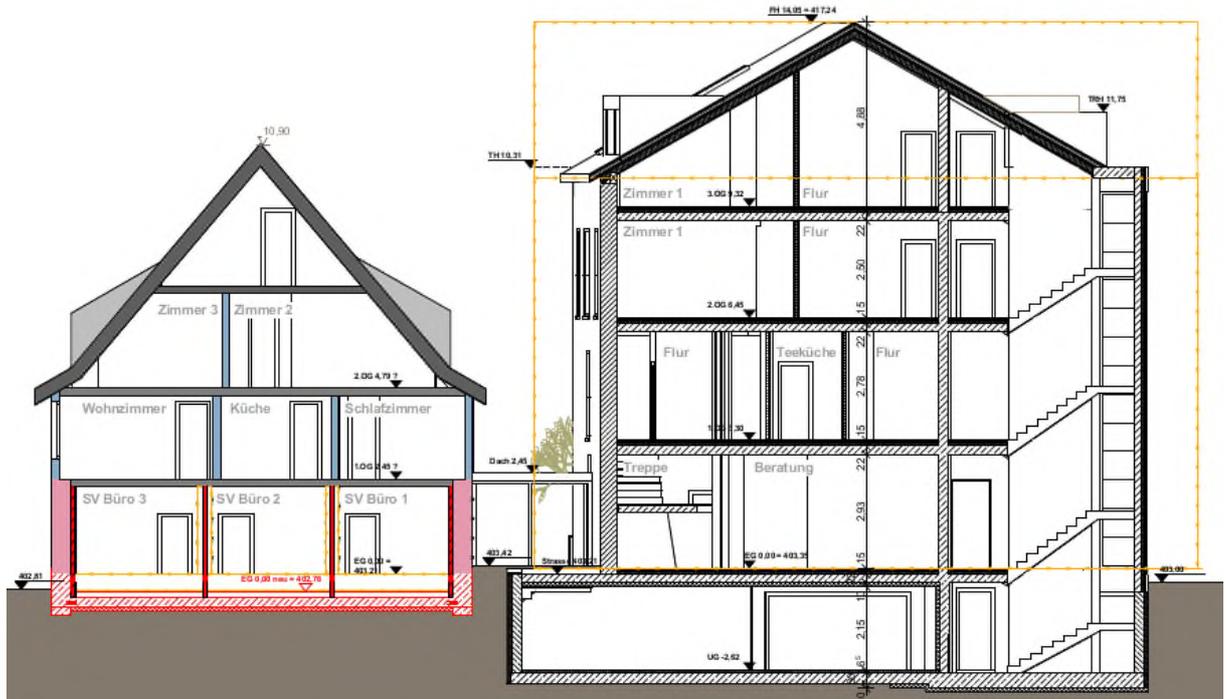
Schnitt durch den geplanten Neubau mit Untergeschoss, links Umbau nicht unterkellertes Nachbargebäude (aus Unterlage 2.4)
